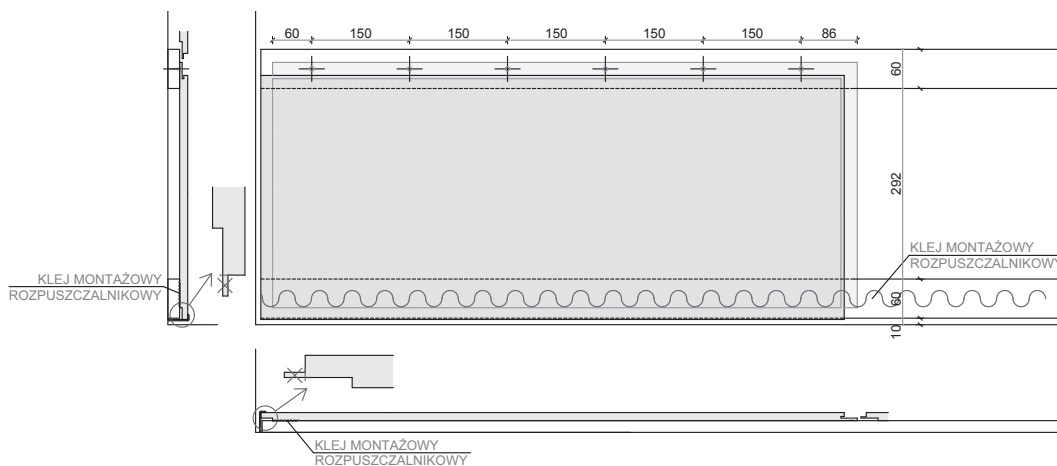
Монтаж первого элемента на планках – монтаж по горизонтали.
